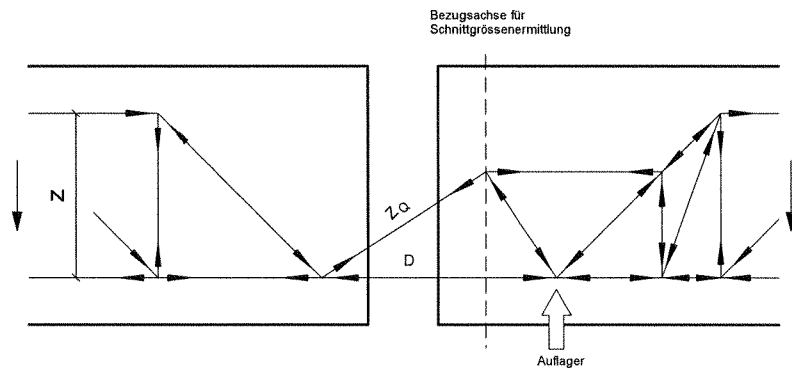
egcobox Plattenelement Fachwerkmodell Typ PV-F; PV-D-F; PV-DD-F
